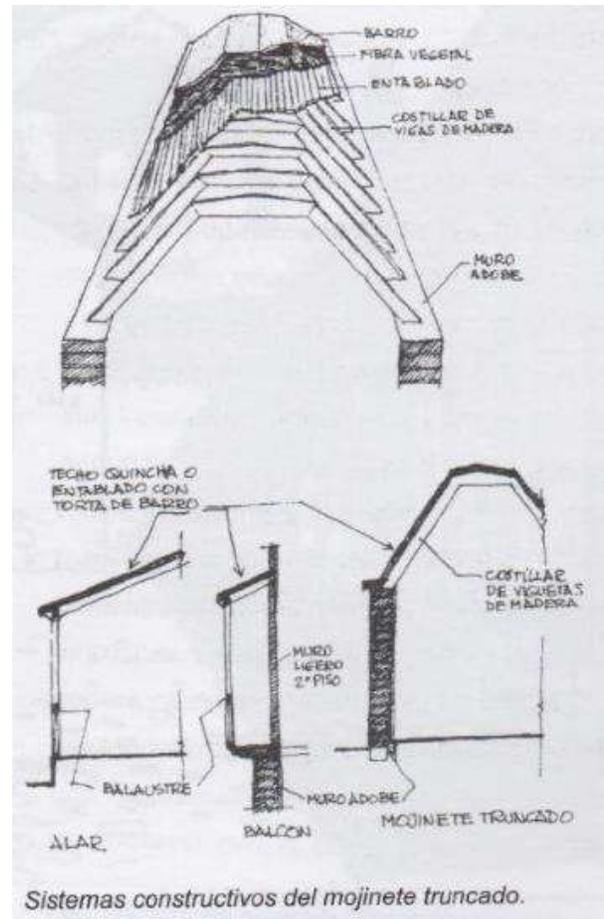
Sistemas Constructivos de Mojinetes Truncados
